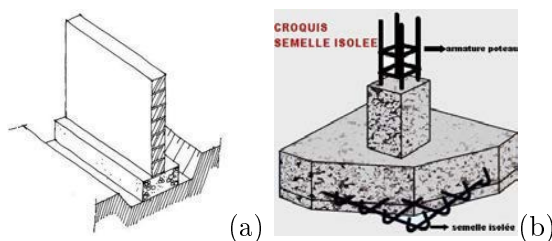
Semelle filante (a) et semelle isolée (b)
